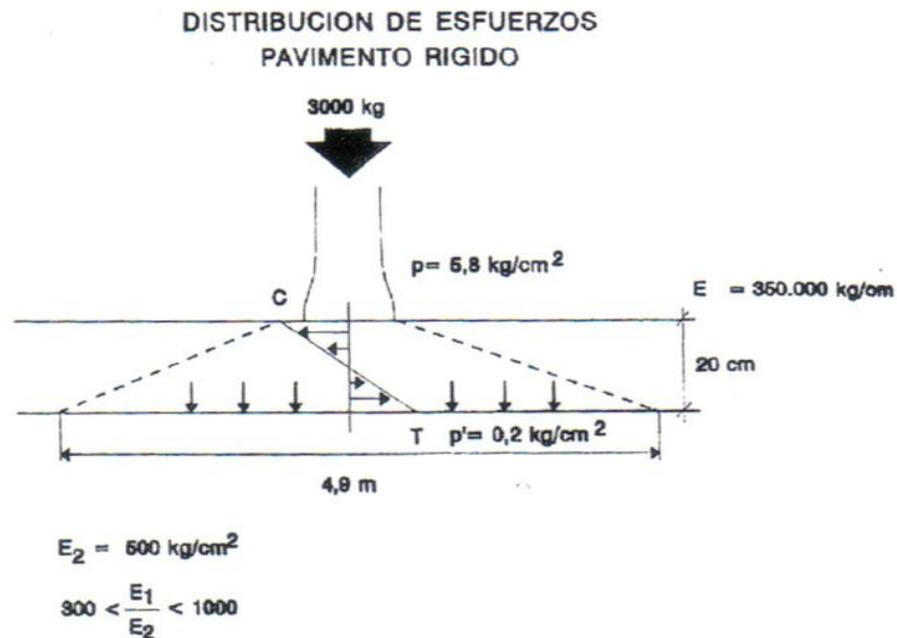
Distribución de esfuerzos en pavimento rígido
